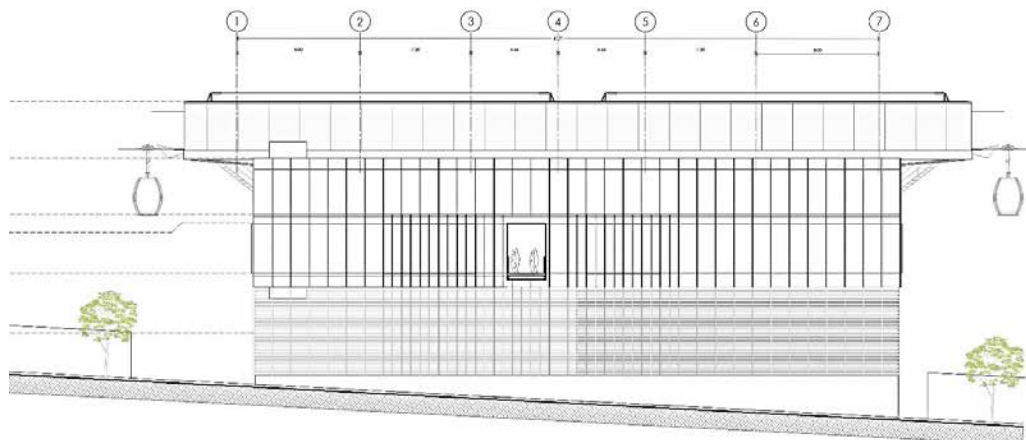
Fachada Sur Estación 4 Lienzo Charro
